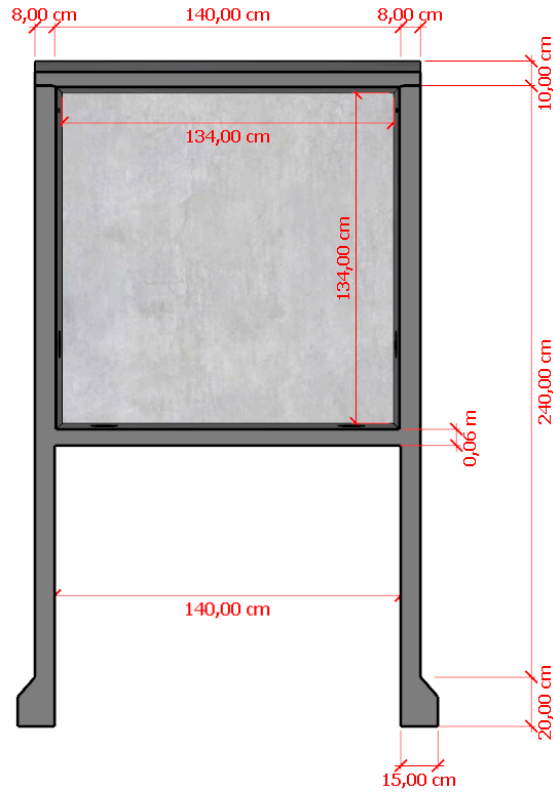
vista frontal interna da cabine de medição com as principais dimensões
